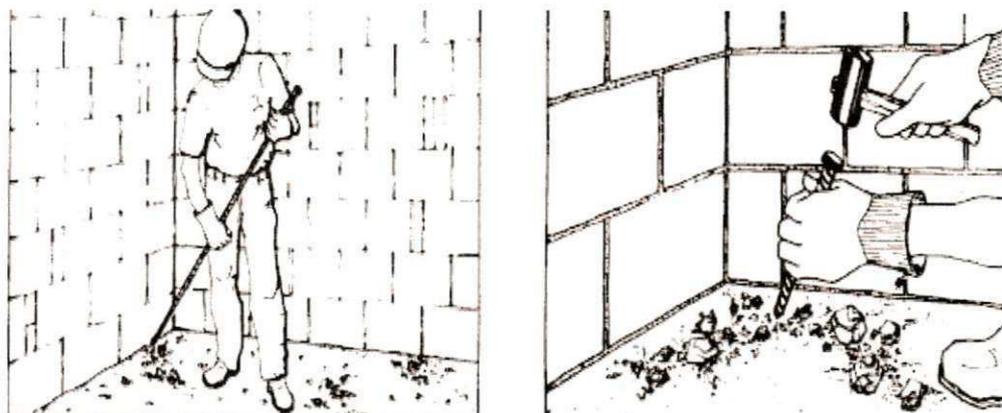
Remoção de detritos aderidos a laje utilizando um vanga ou ponteira e picão e marreta.
